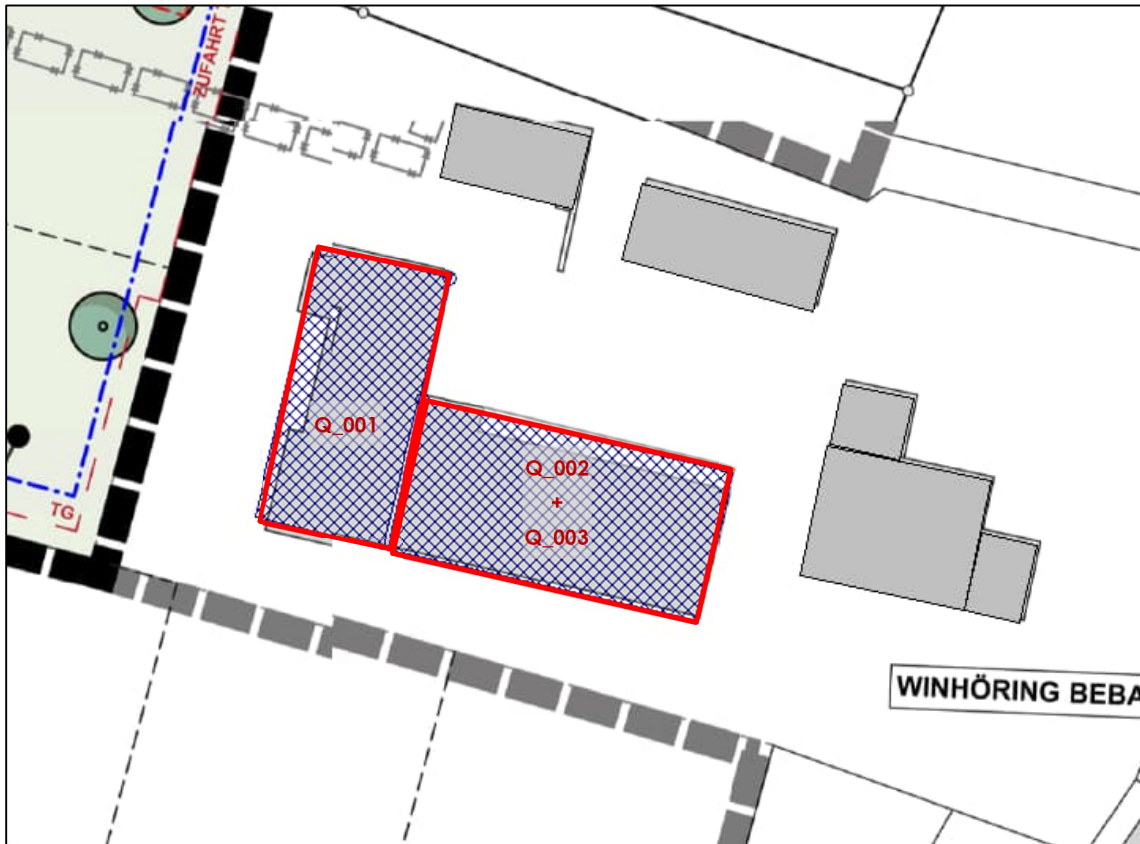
Lageplan mit Darstellung der modellierten Quellen
